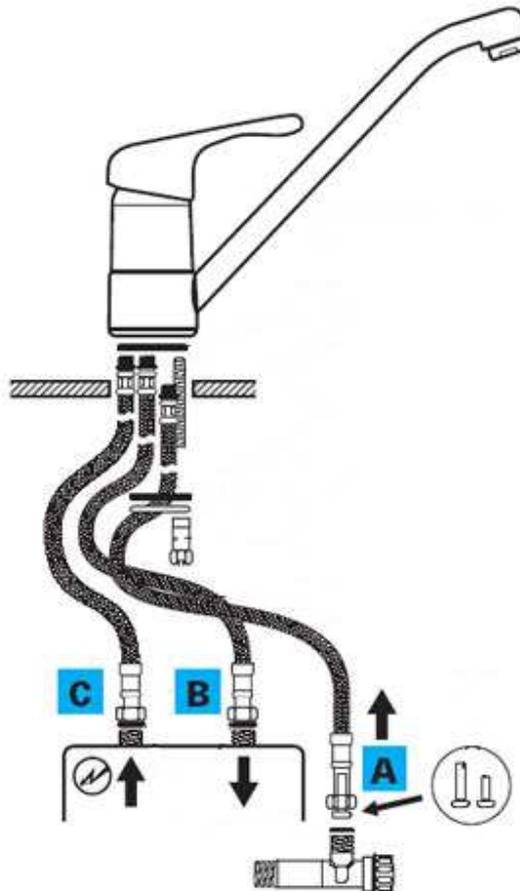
Niederdruck Einhebelmischer mit starrem Schwenkauslauf
